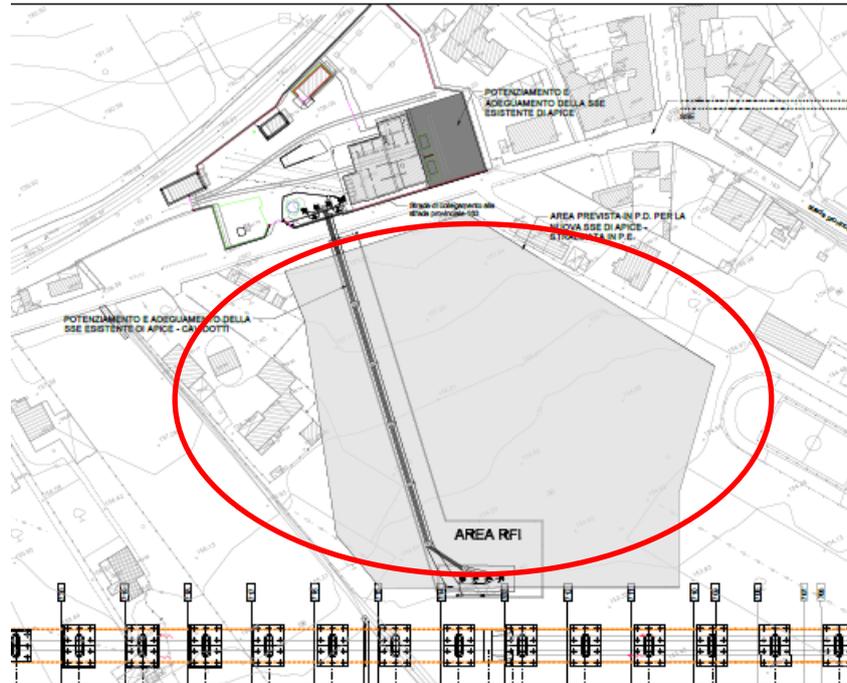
Planimetria della SSE Apice come da prescrizione in oggetto
